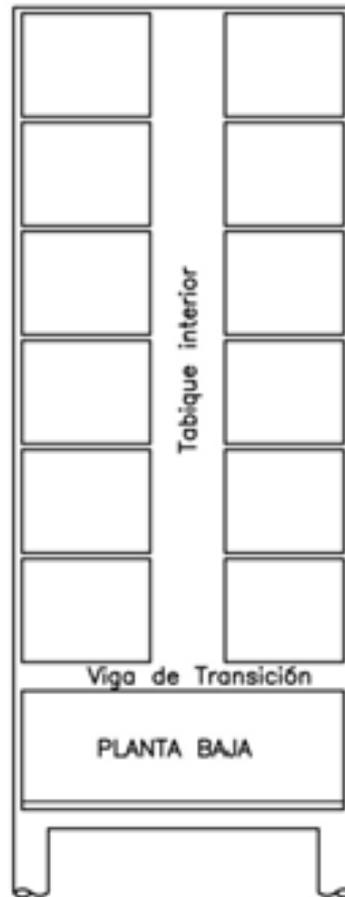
Corte esquemático de estructura de transición. Fuente: Elaboración propia
